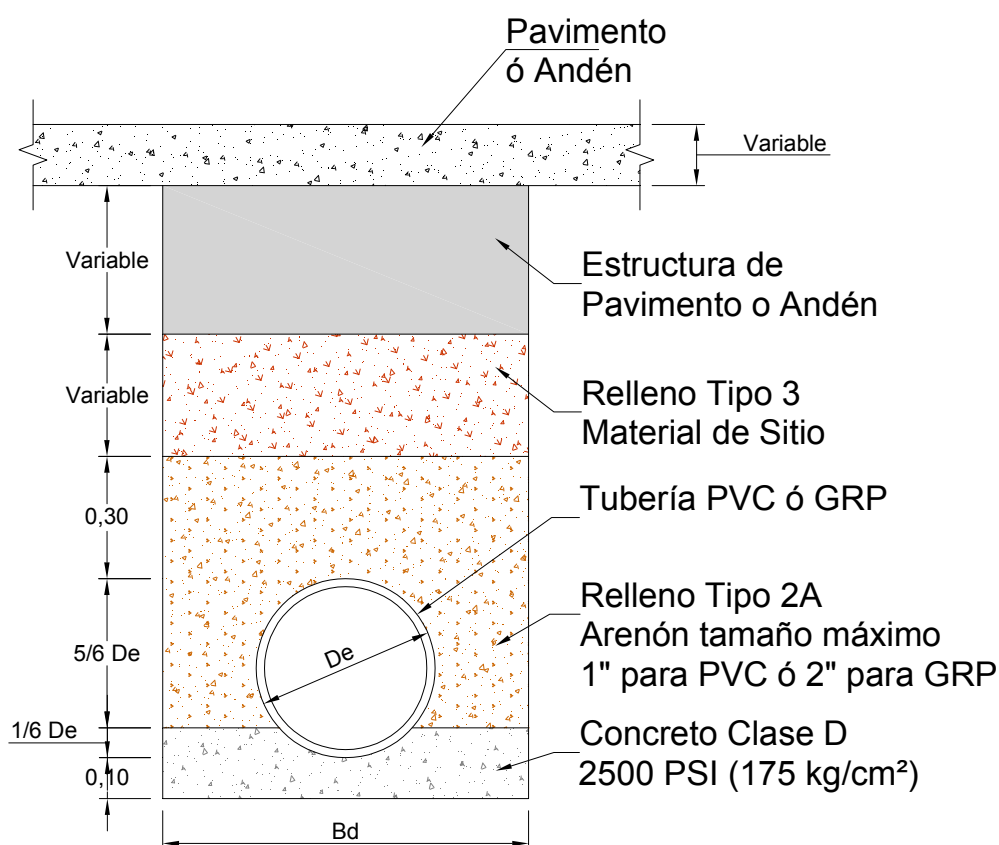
Cimentación Típica de tubería para Pendientes entre 20% y 33%
